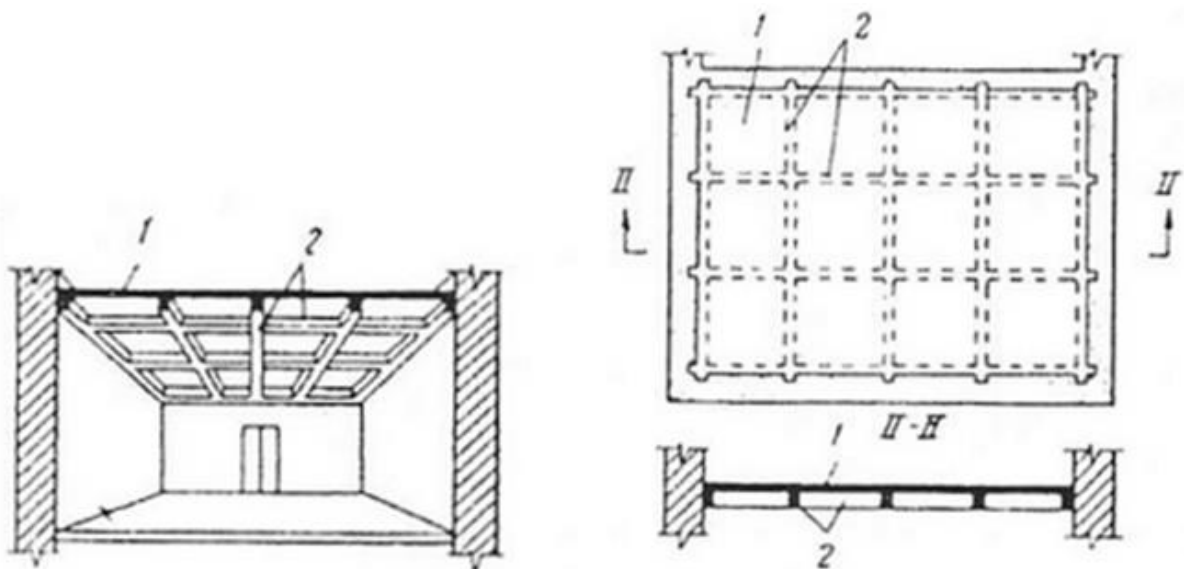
Монолітне залізобетонне кесонне перекрыття: 1– плита; 2– балка
